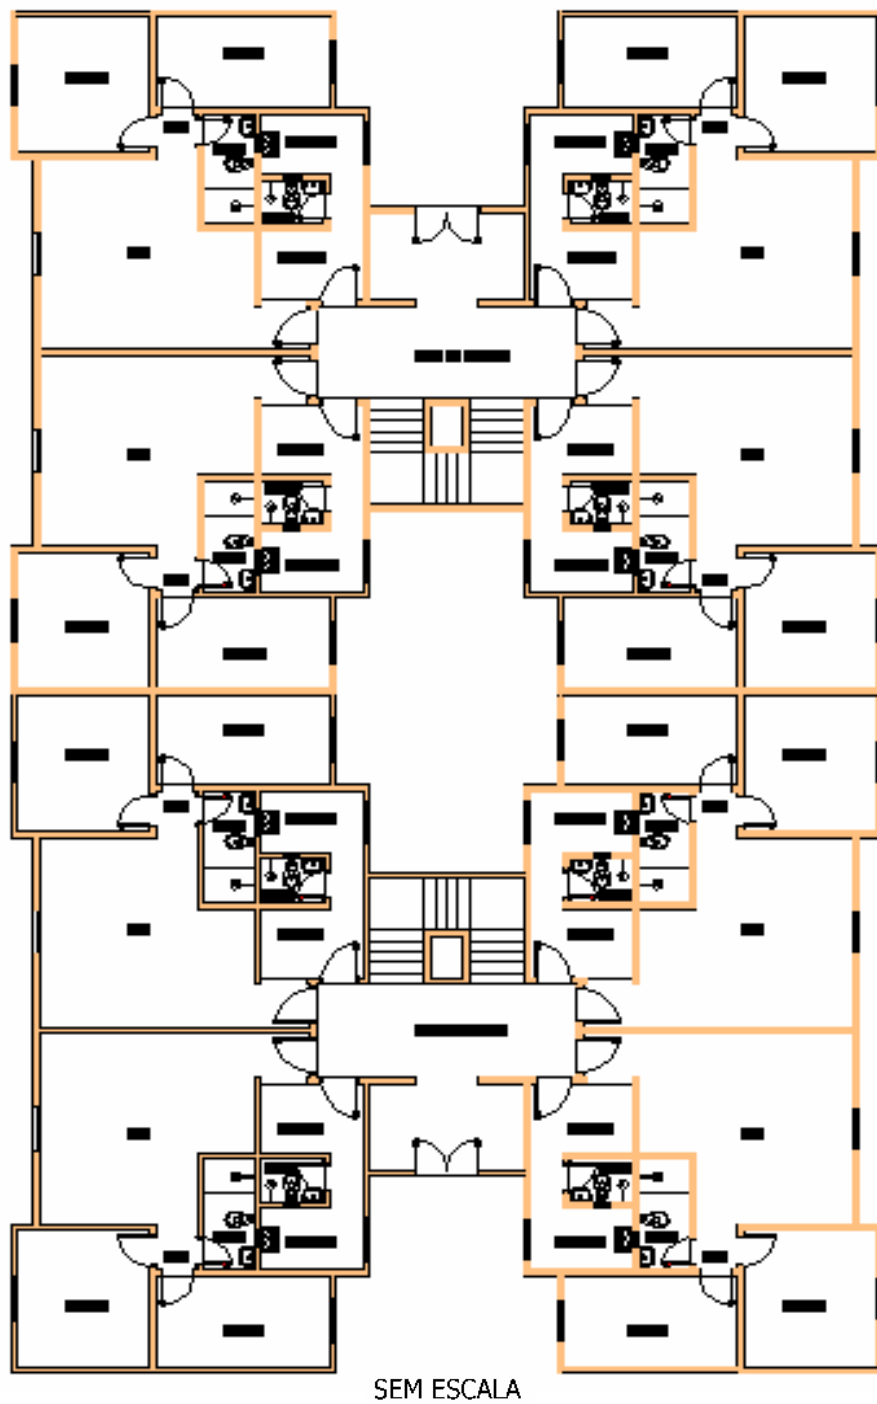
Planta Baixa ilustrativa do pavimento Tipo
